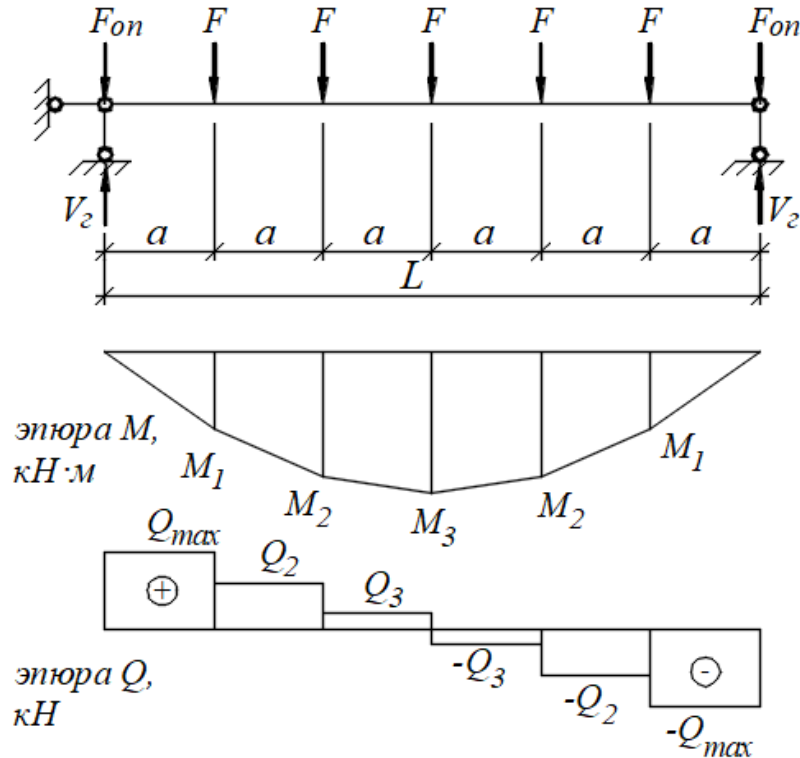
Расчётная схема и эпюры внутренних усилий в главной балке
